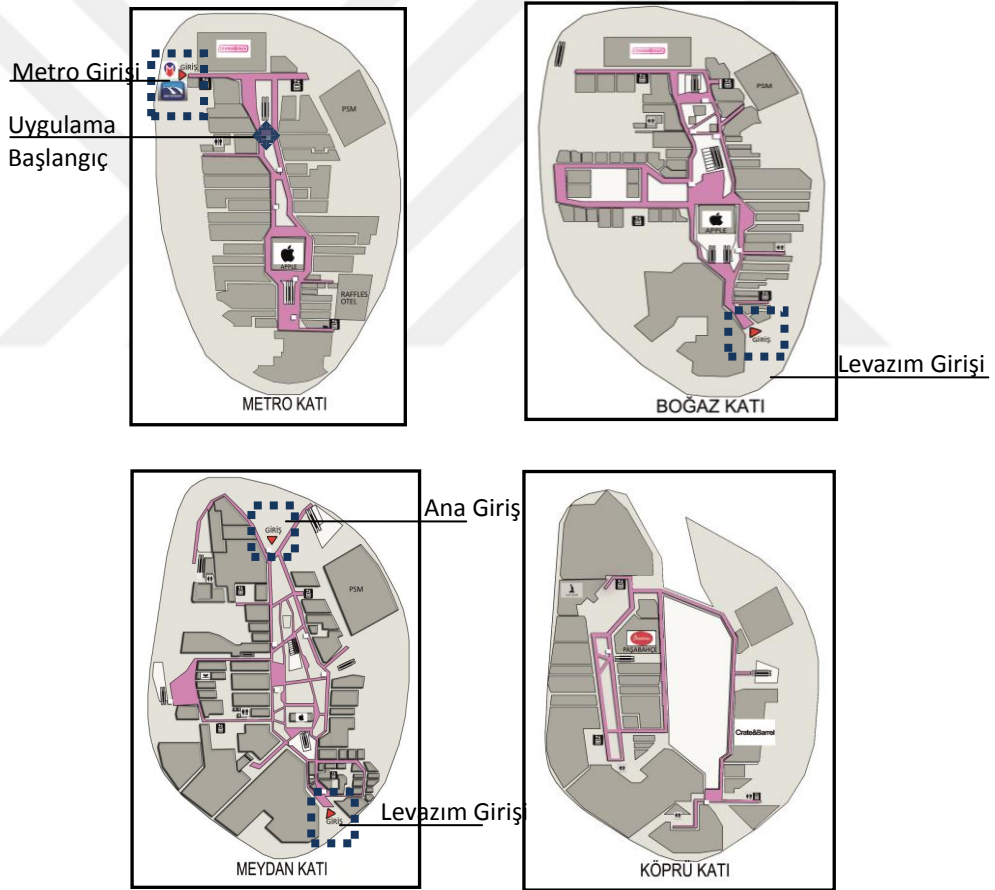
3 Zorlu Center Vaziyet Planı [63]
